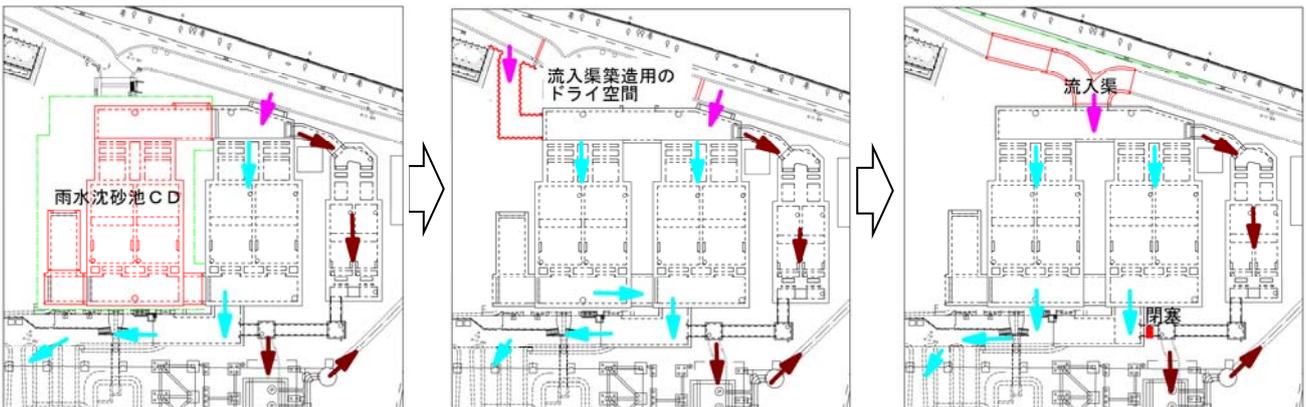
施工ステップ2 (雨水沈砂池C D及び流入渠築造)
